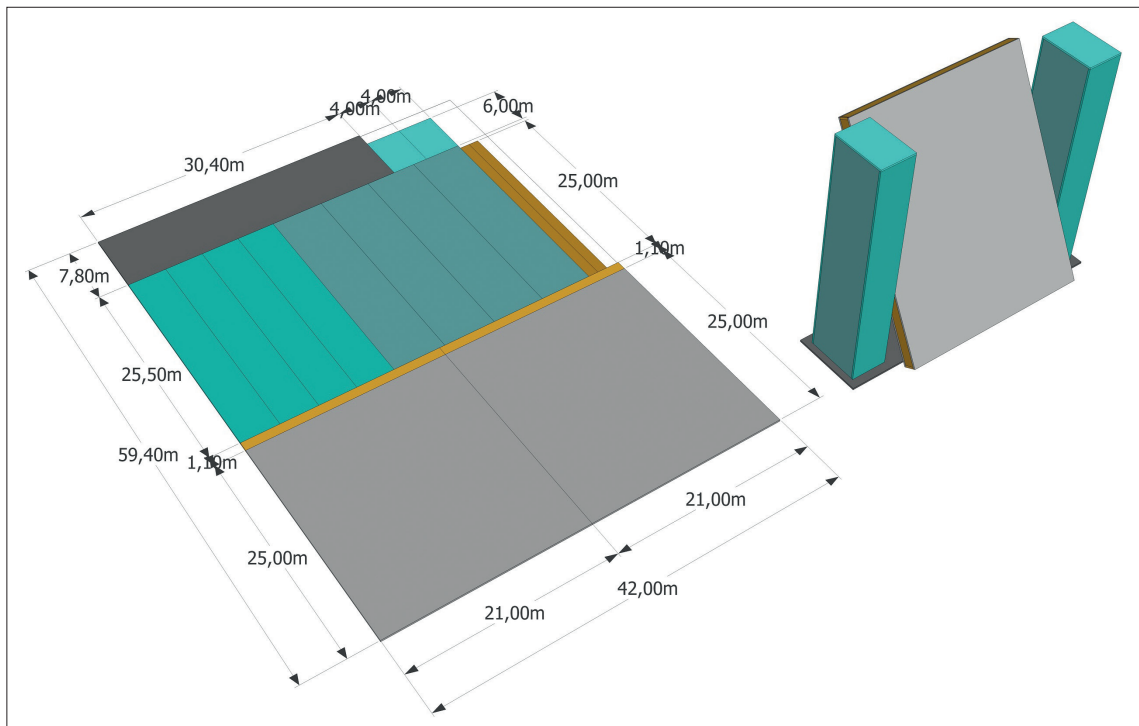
Planificación del prototipo de un módulo en escala de 1:1. Fuente: Elaboración de los autores.
